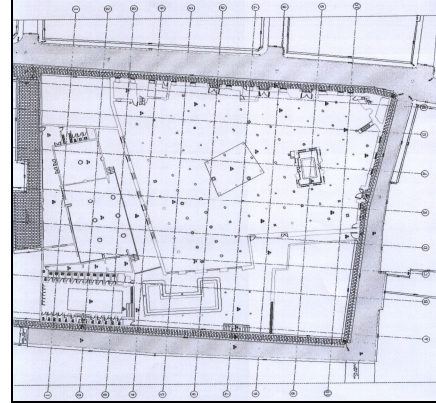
جامع زغول: رشيد: المسقط الأفقي
